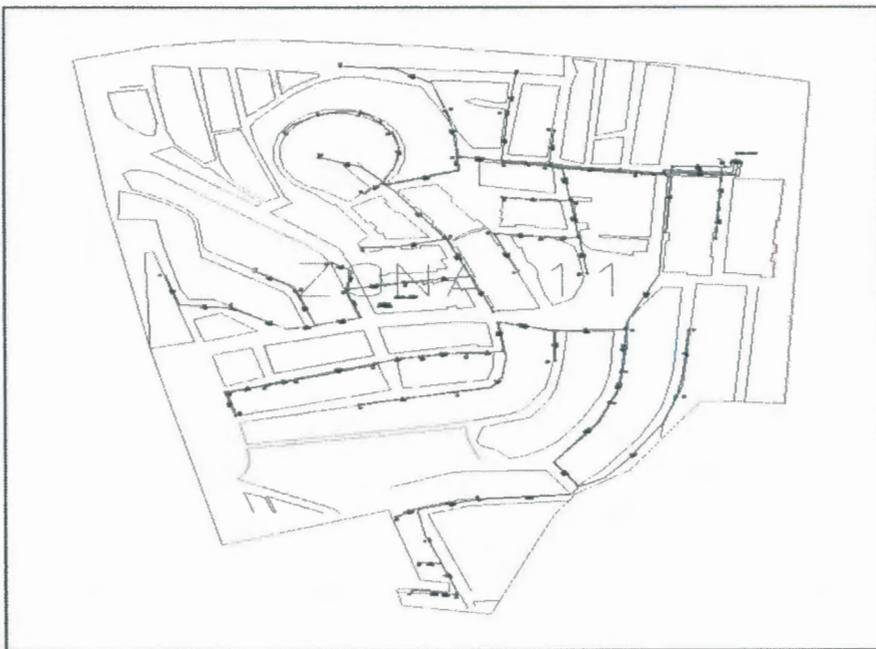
Planimetría zona 11 del sector de la vía a Daule
